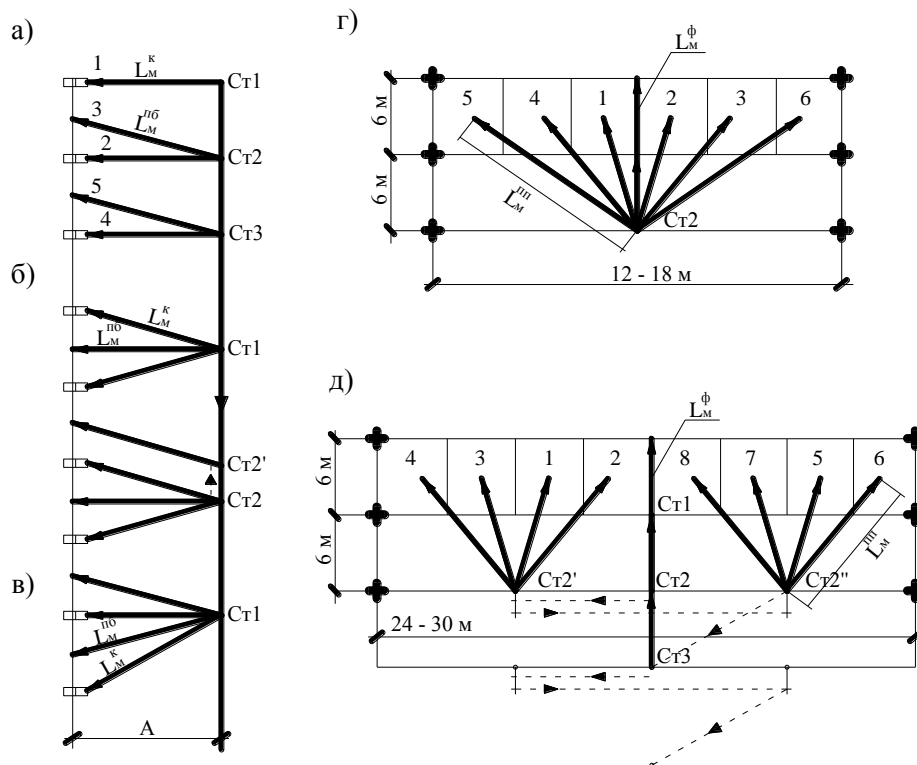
Схеми проходки крана і послідовність монтажу конструкцій під час монтажу одноповерхового промислового будинку:
